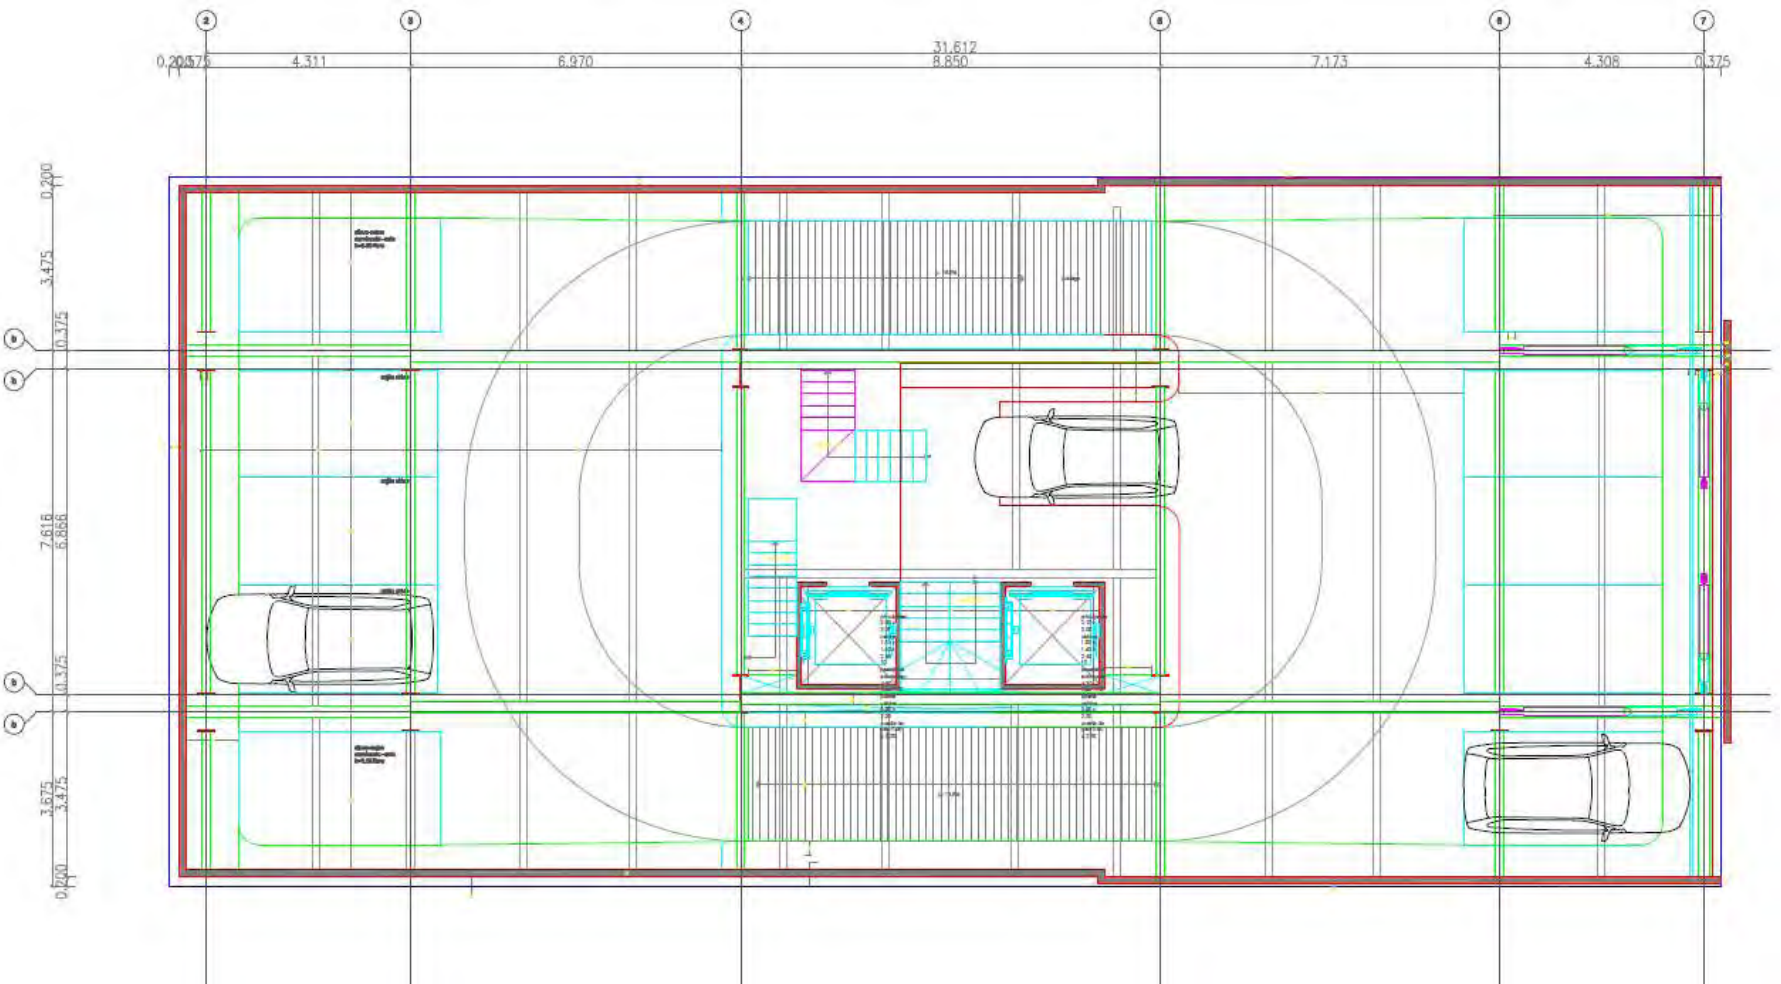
PLANTA TIPO ESTACIONAMIENTO (NIVEL 1 Y 2)
